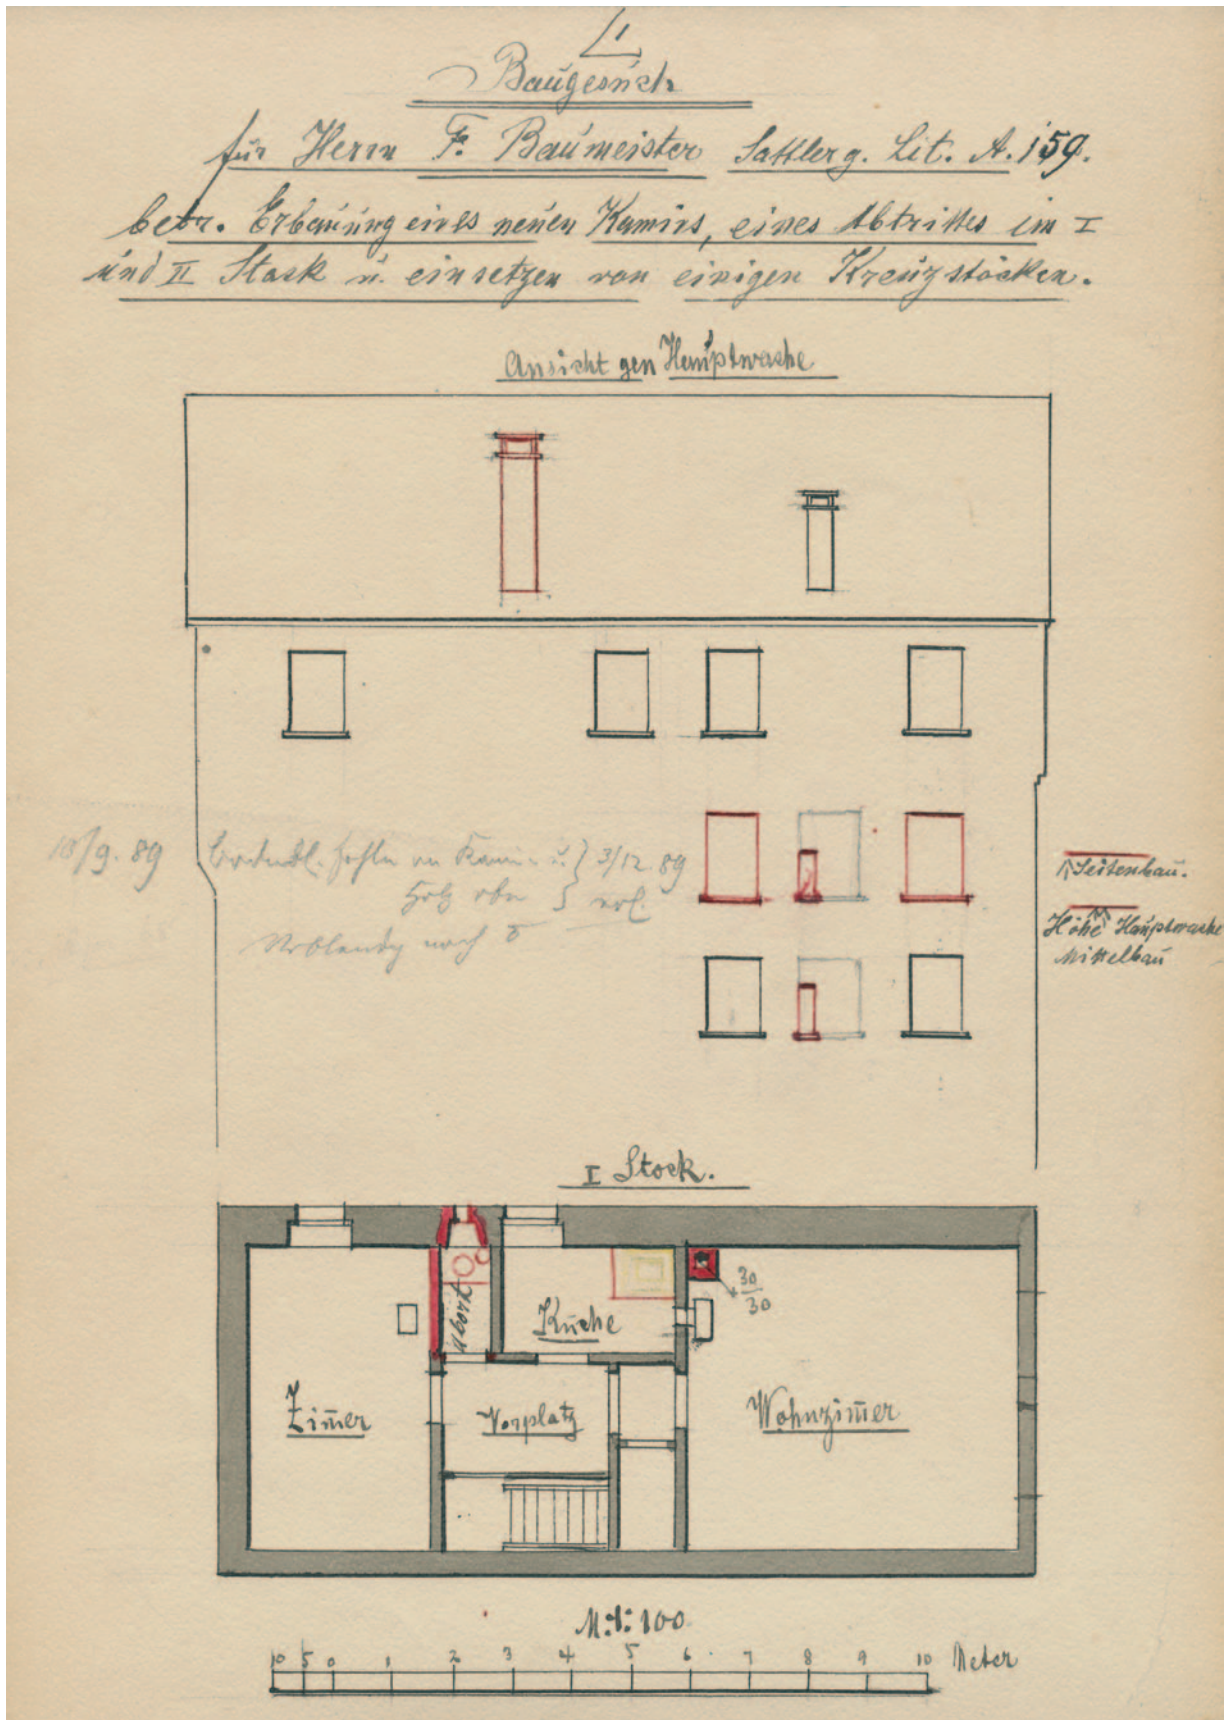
Gebäude Sattlergasse 17 (A 159), Ansicht gegen die Hauptwache und Grundriss 1. Stock, Baugesuch 1889.
